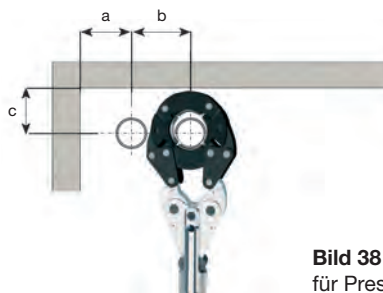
Mindesteinbaumasse für Pressschlinge/-kette
